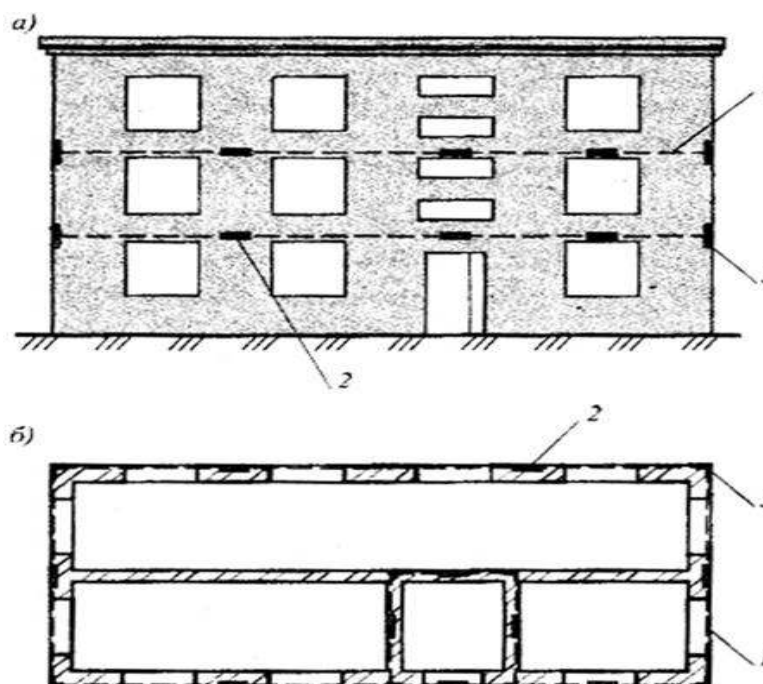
Усиление стен стальными тяжами, устанавливаемыми в стенах:
